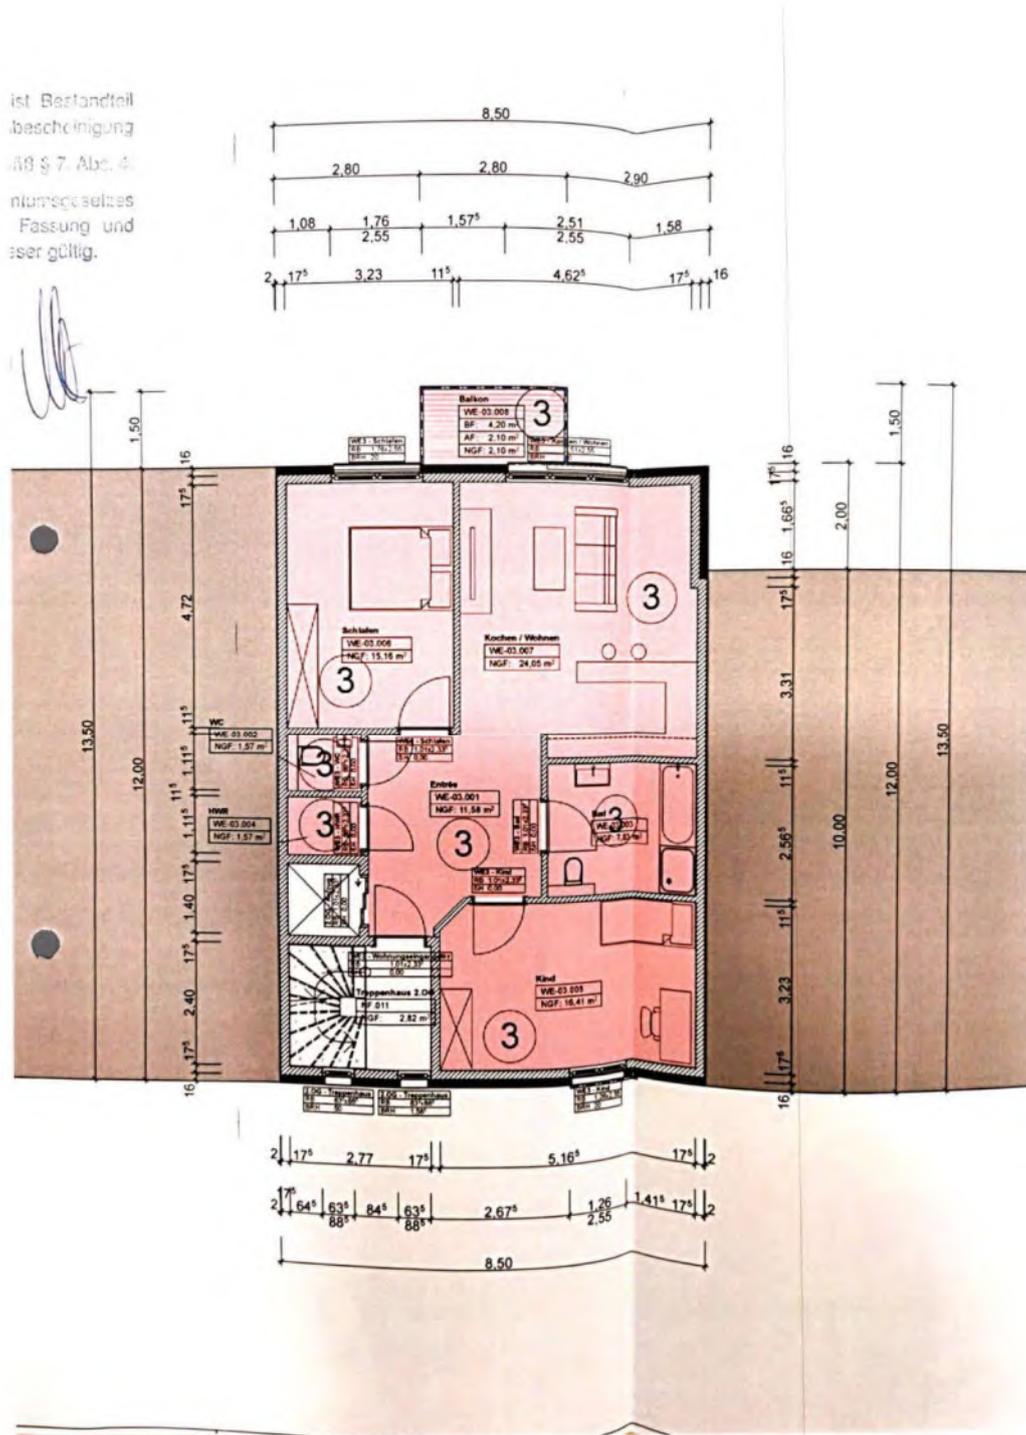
Grundriss 1.OG mit Wohnung Nr. 3
